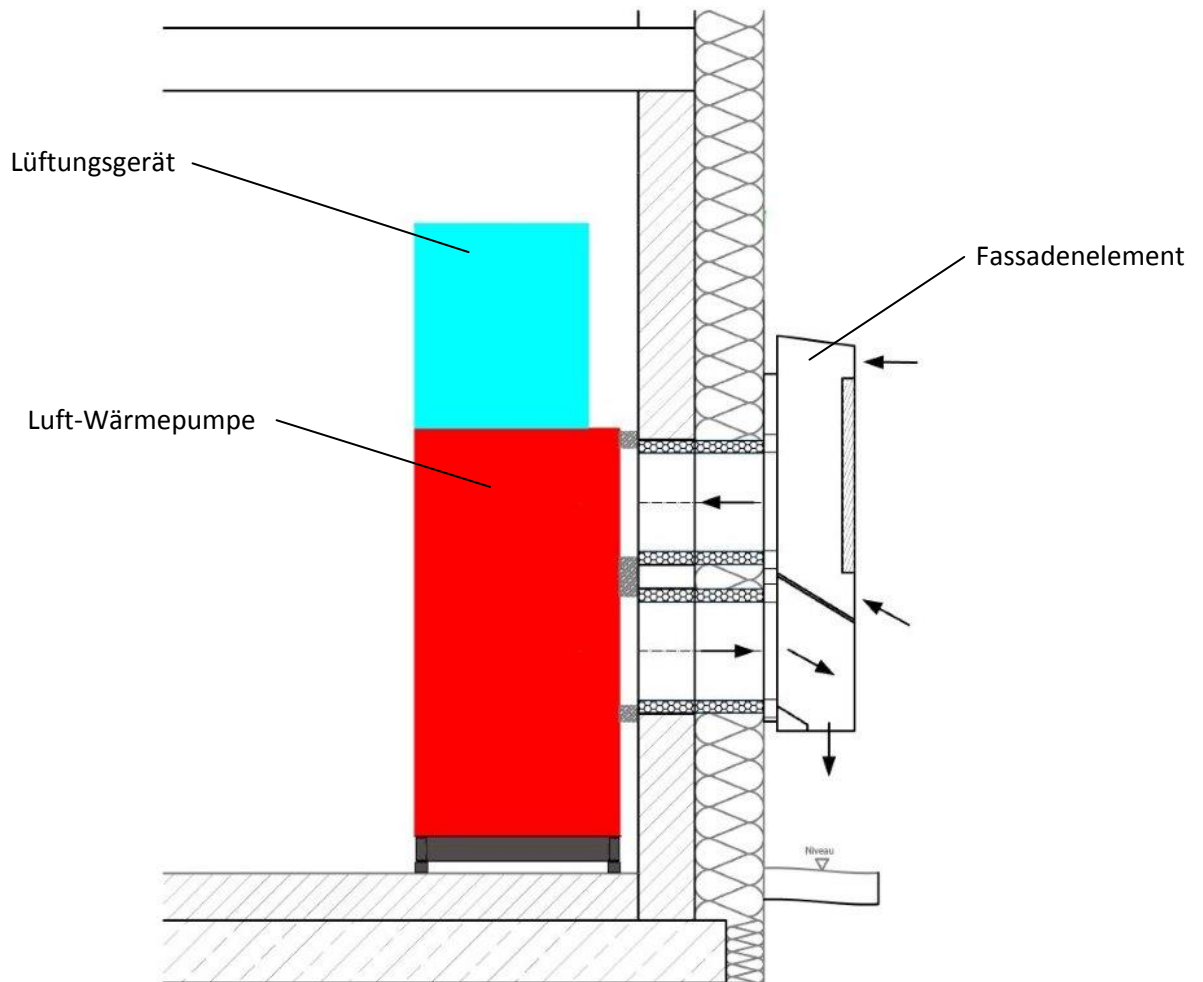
Einbaubeispiel Wärmepumpe mit Fassadenelement⁴⁷
